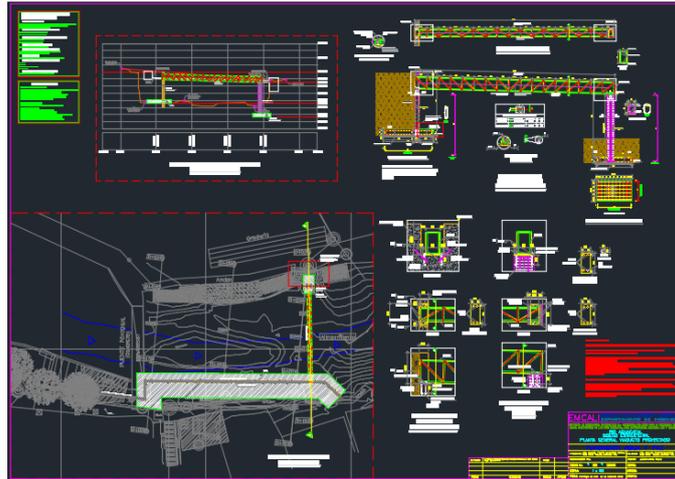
Diseño estructural y ubicación del muro de contención.
